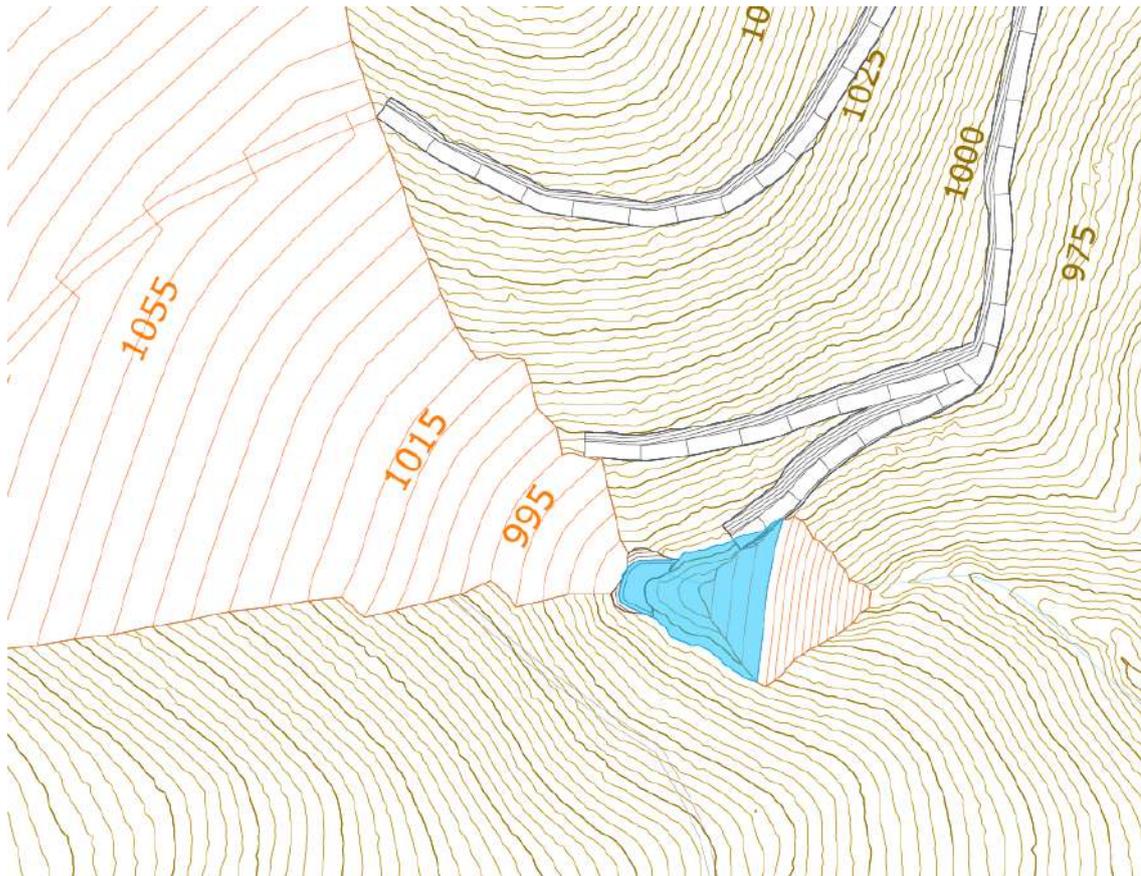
Planta de la balsa de decantación al pie de la escombrera sur.
